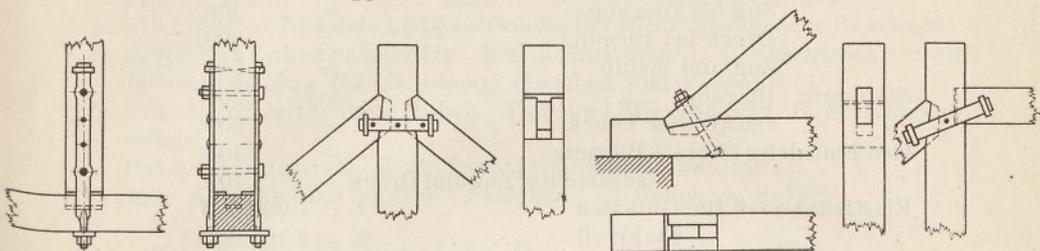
Verbindungen der Knotenpunkte von Hängewerken.
